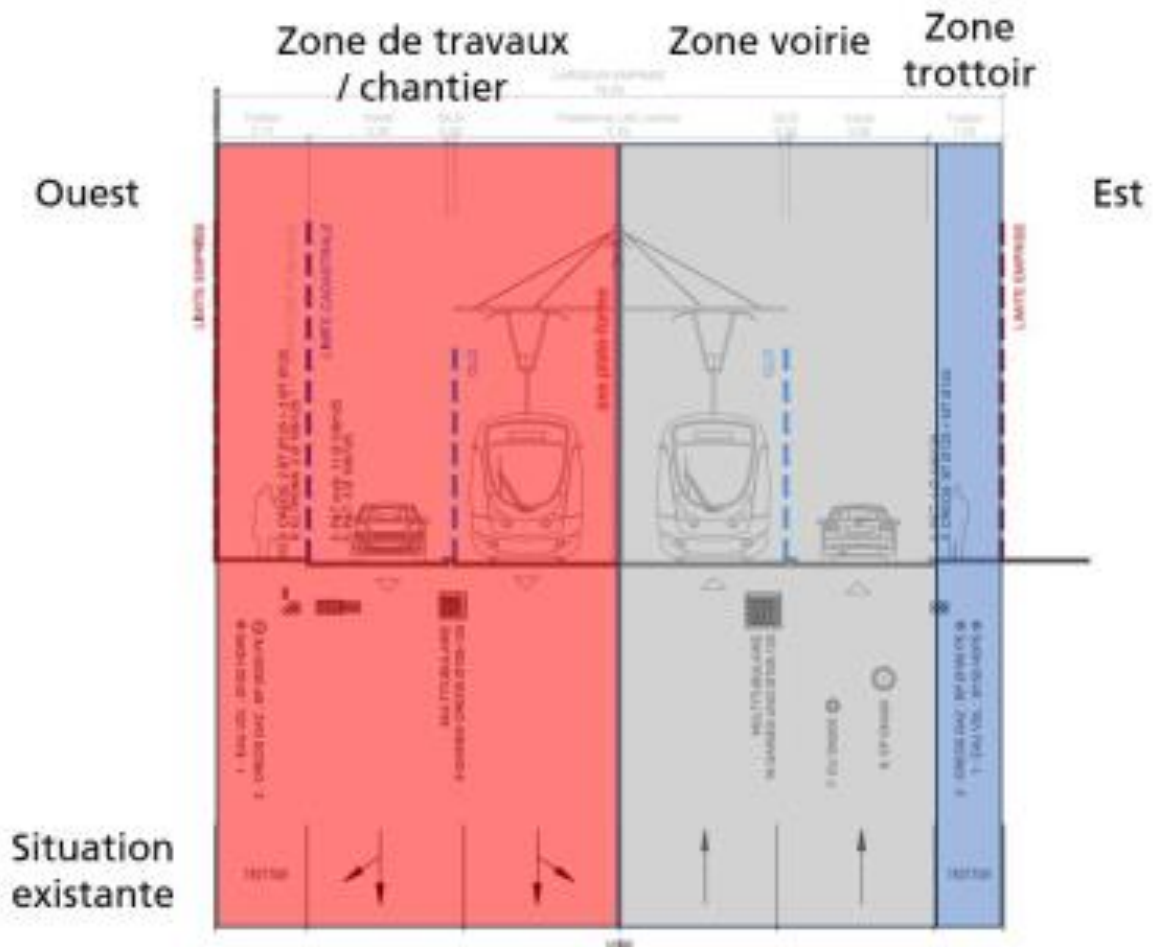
Phase de construction : 2. Source : APS, Volume E - Planning, Avril 2025.
